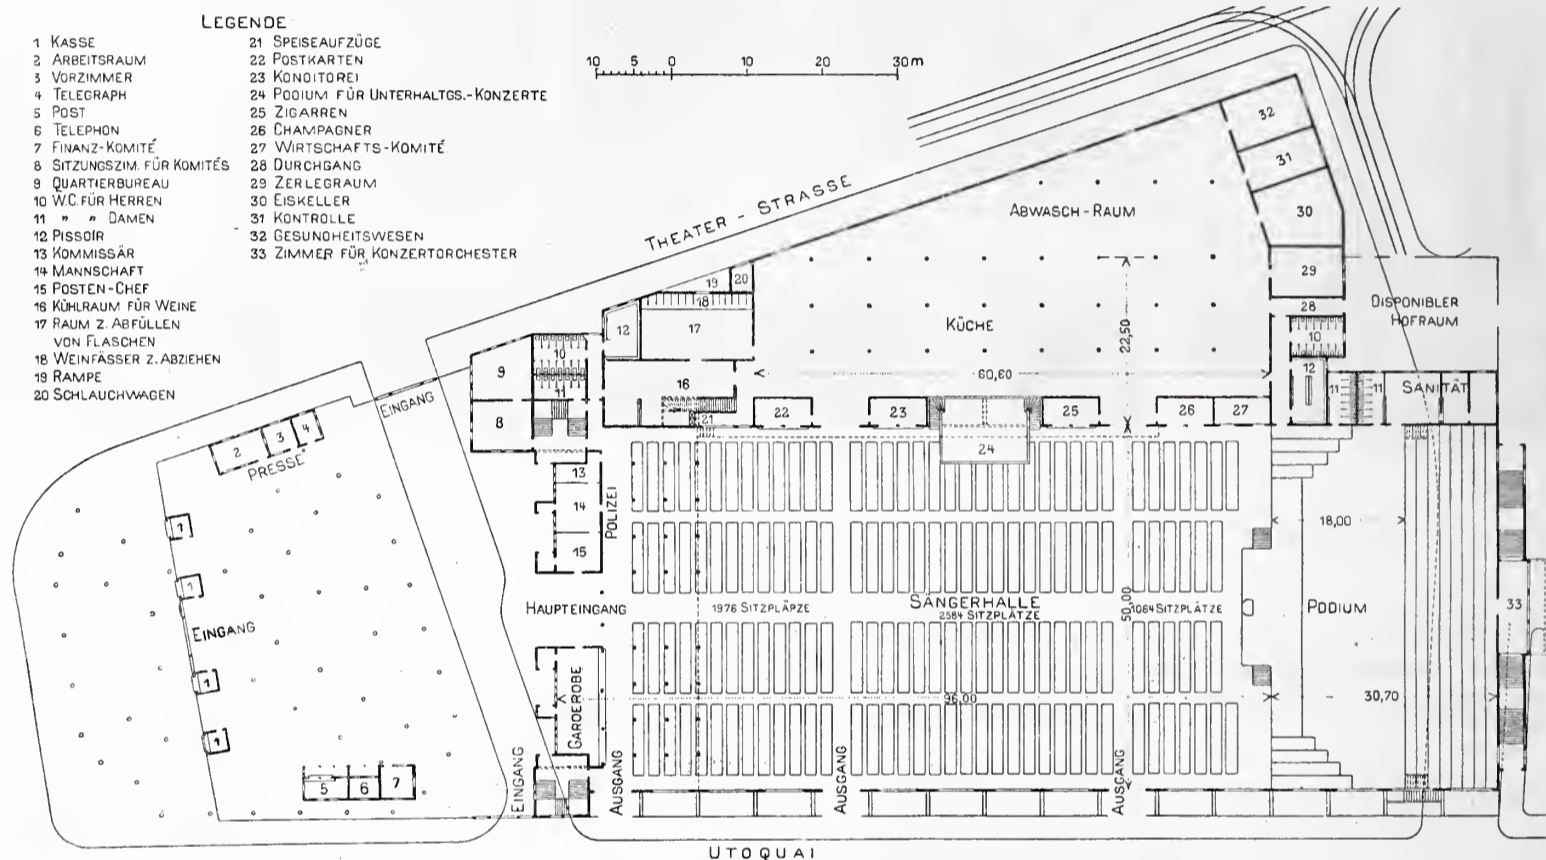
Lageplan und Grundriss der Festhalle. — Masstab 1 : 1200.
